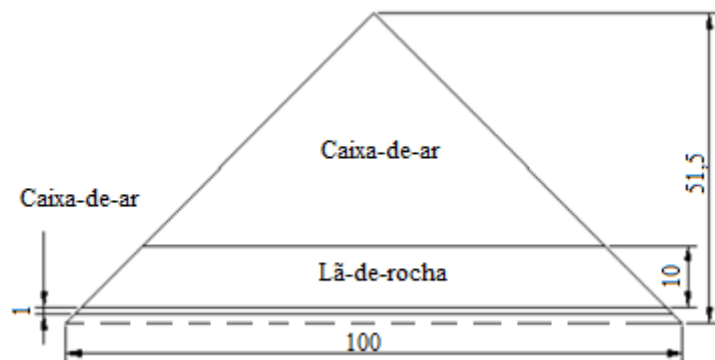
Dimensões [cm] em planta: painel perfurado com lã-de-rocha de 100 mm (P100)
